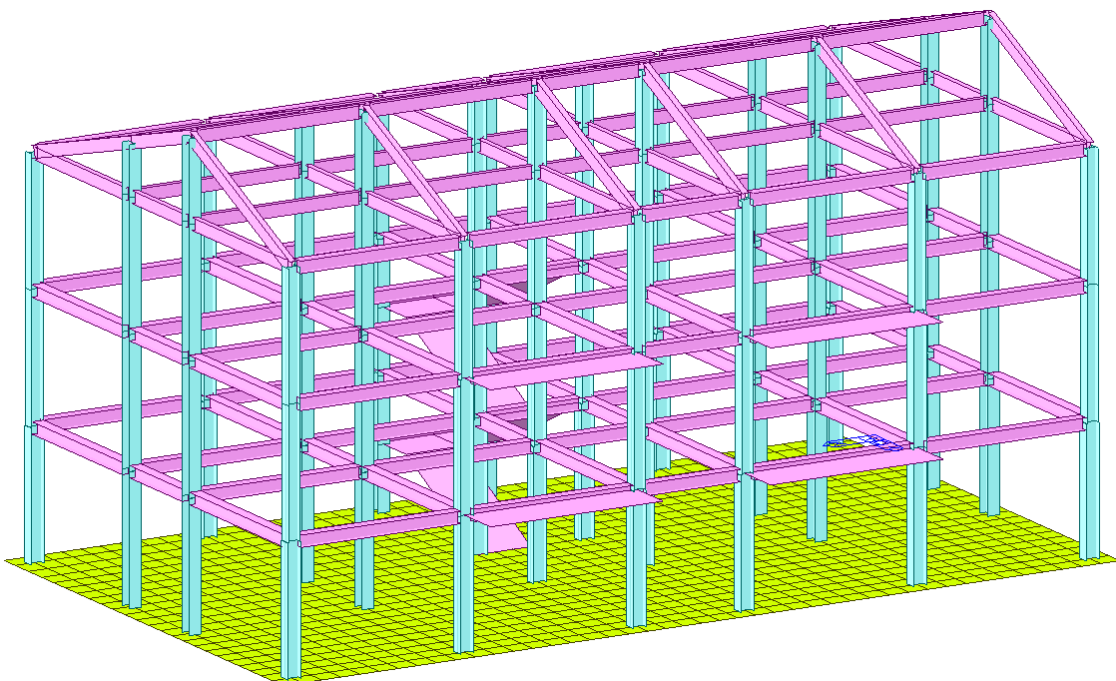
Modello FEM edificio a tre piani in acciaio con platea di fondazione - Vista assometrica 2.
